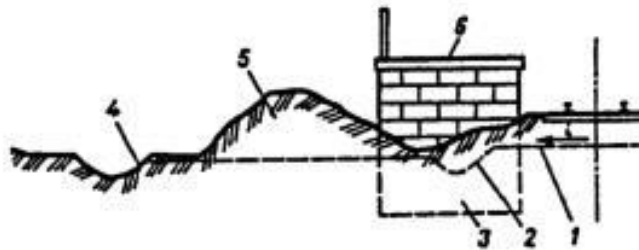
Осадки основной площадки земляного полотна над трубопроводными пересечениями
